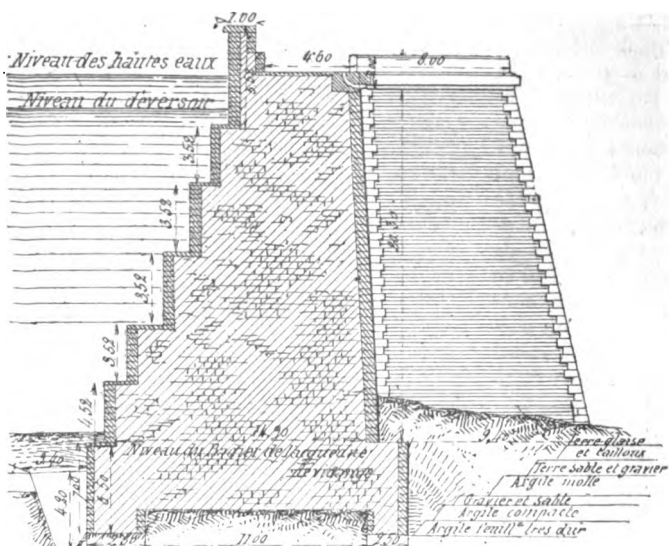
Section transversale du barrage de Grosbois, montrant l'élévation d'un contrefort.
